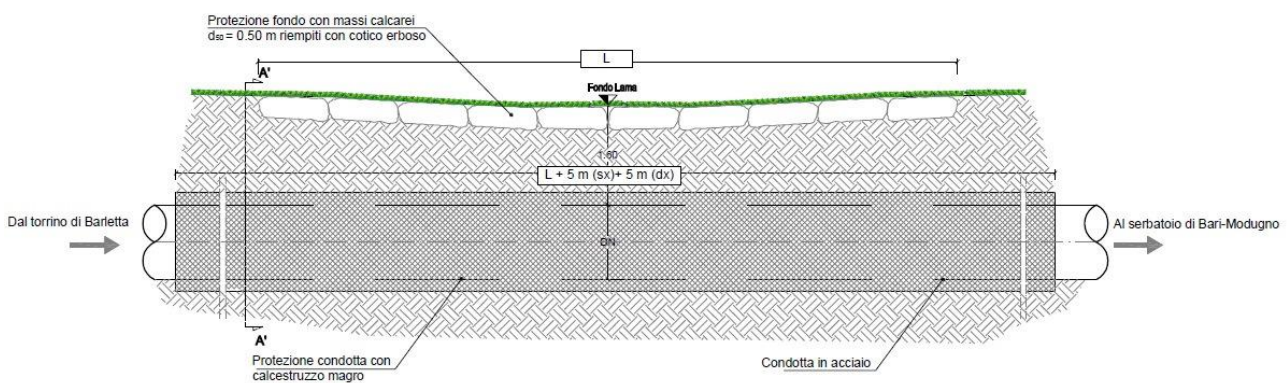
Sezione trasversale reticolo con protezione in massi e annegamento della condotta in calcestruzzo magro.
